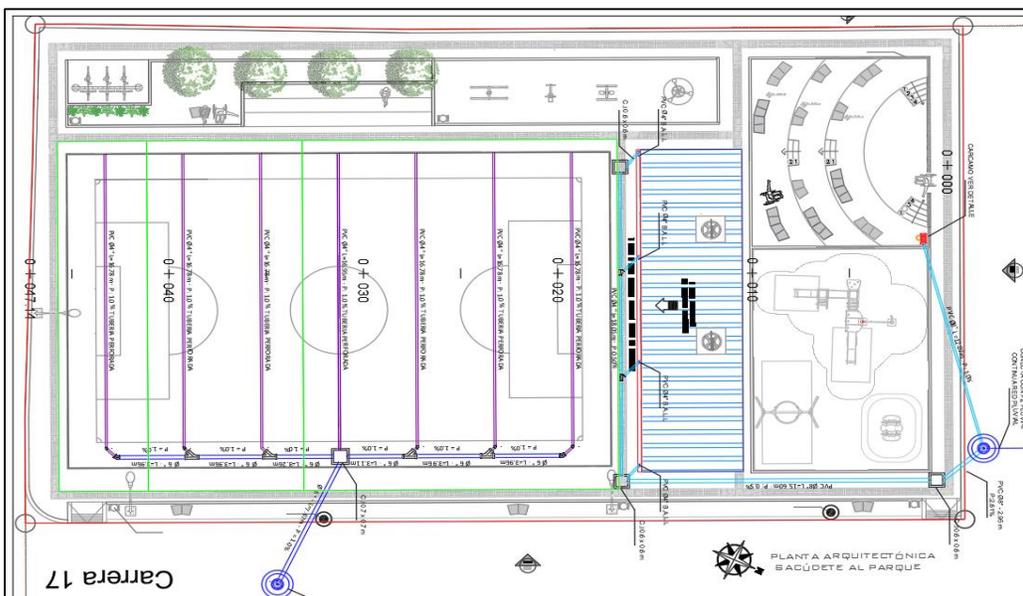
Red de Aguas Lluvias y Drenajes (Alcantarillado Pluvial)
